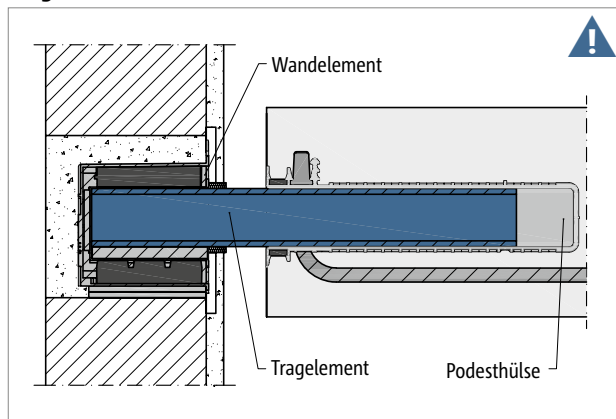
Tronsole® P: Mehrteiliges Produkt (Wandelement, Tragelement, Podesthülse); Tragelement (eingefärbt) muss auf der Baustelle eingebaut werden.
